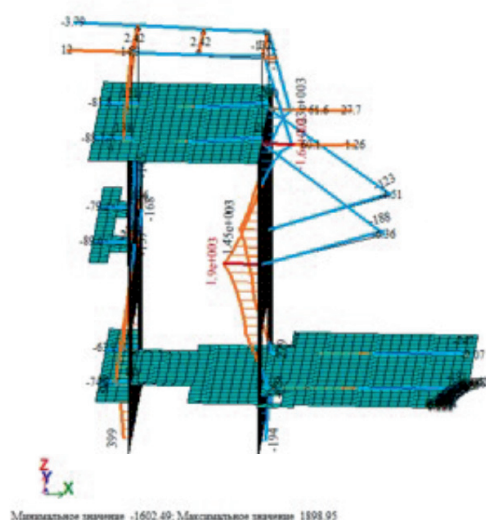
Эпюры продольных сил в сжатых и растянутых элементах стальных ферм, а также поперечных сил в монолитных колоннах в зоне опирания стальных ферм на монолитные конструкции
